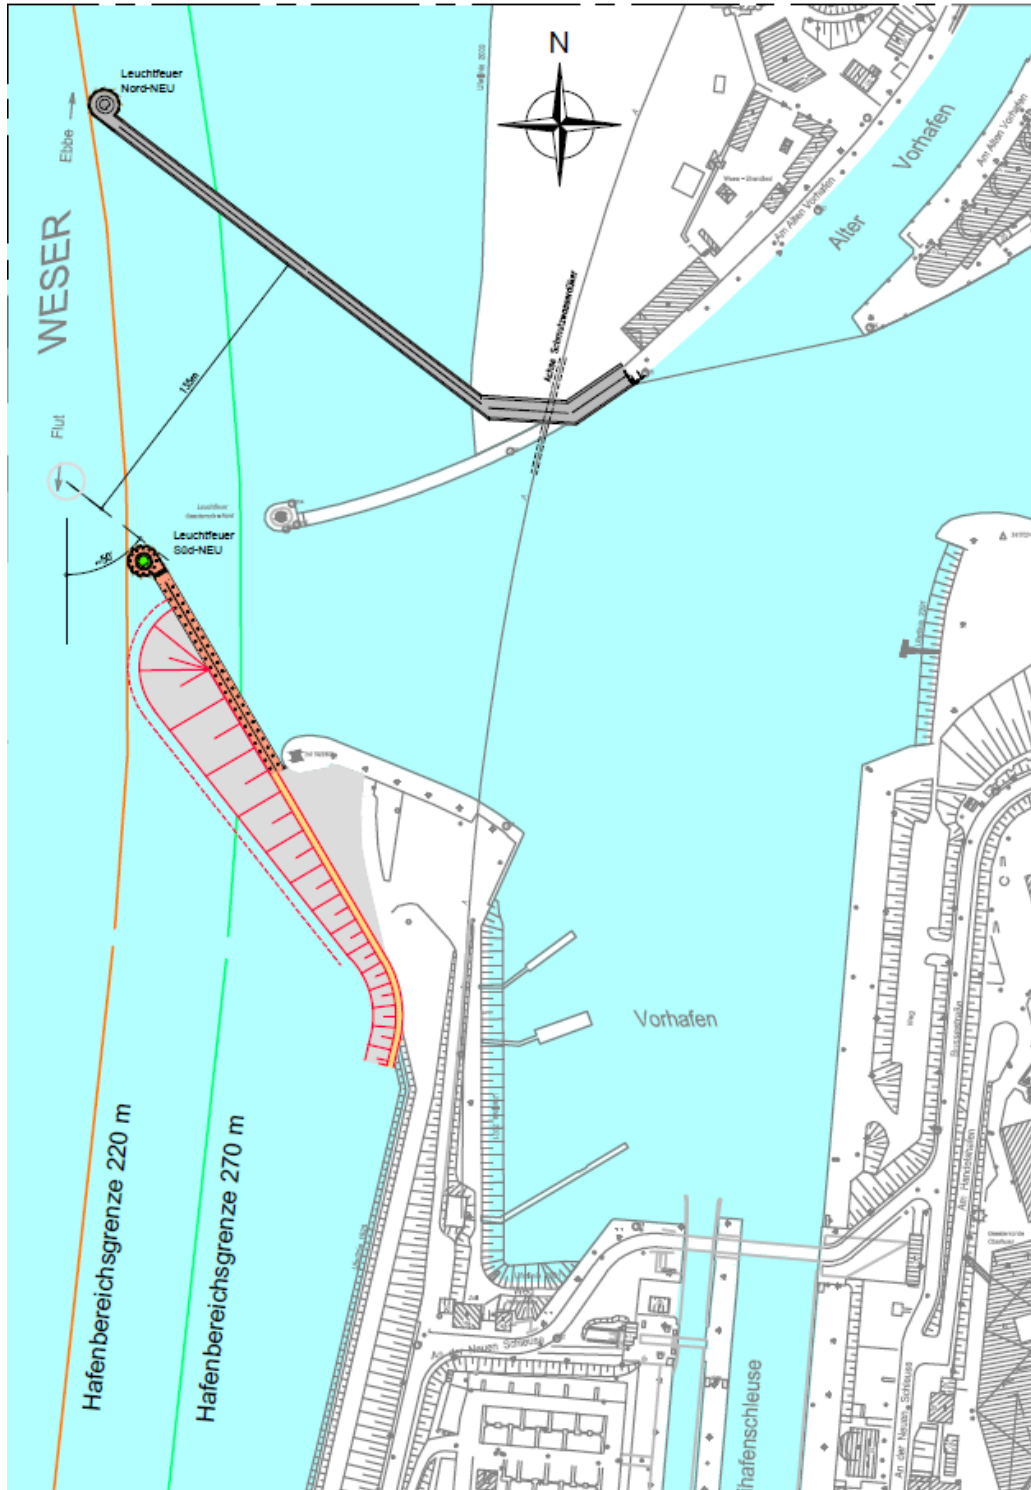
Übersicht Neubau in neuer Lage, Lageplan
